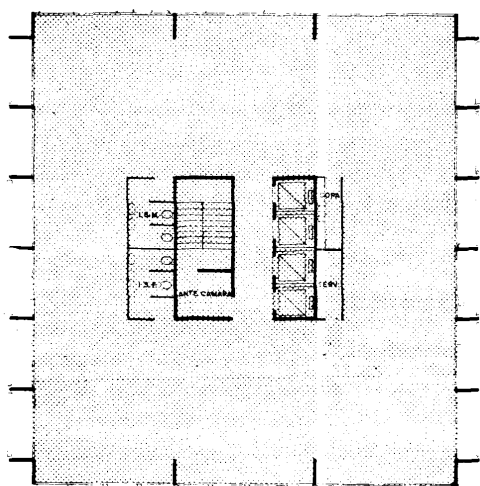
4º prêmio CREA SP; planta tipo da torre; estrutura em pilone central.
